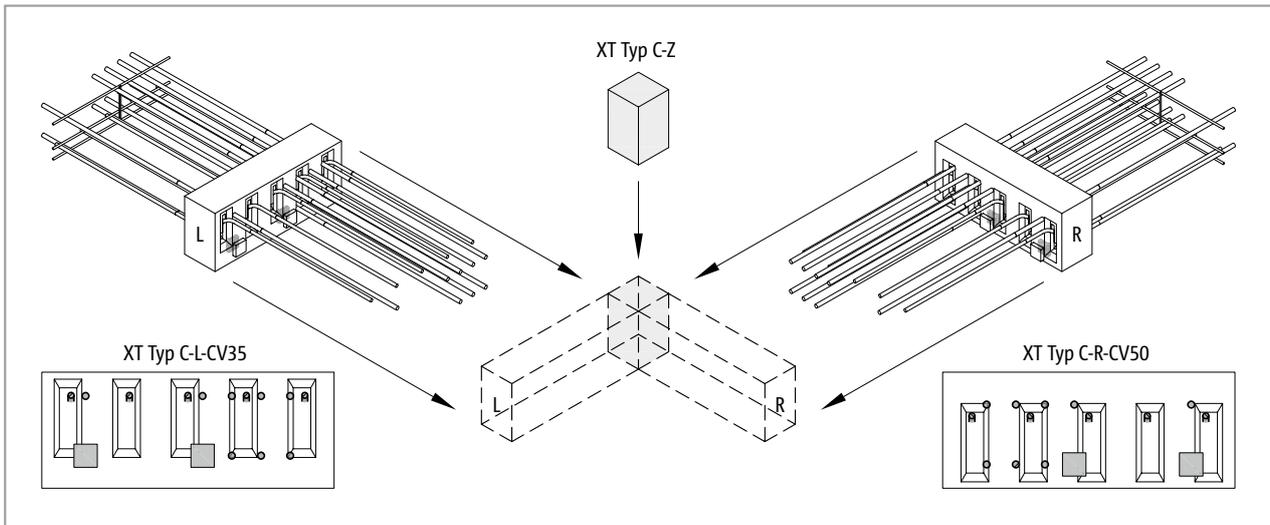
Schöck Isokorb® XT Typ C-L-CV35, XT Typ C-R-CV50: Anordnung an der Ecke mit Eck-Dämmkörper
